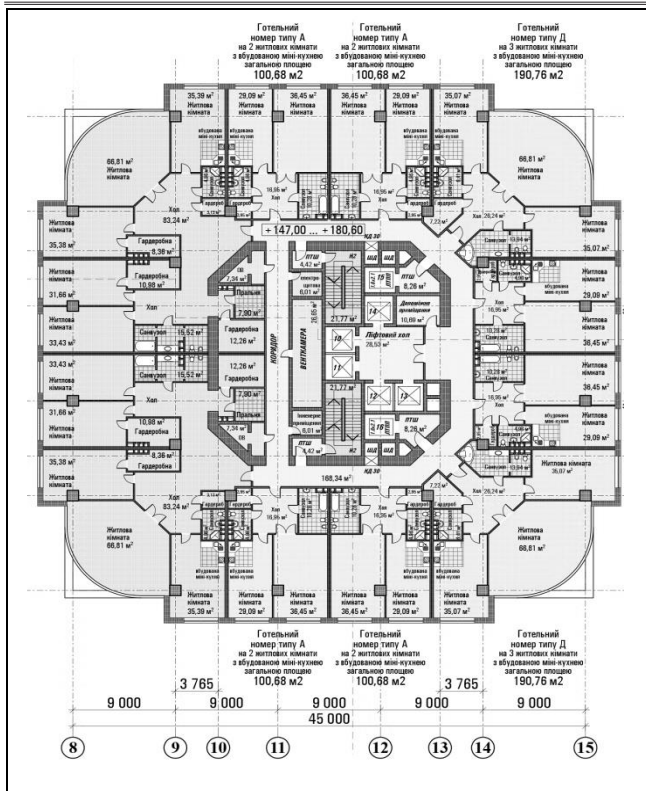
План типового поверху з житловими апартаментами БФЖК. Проект. (Авторське креслення)
